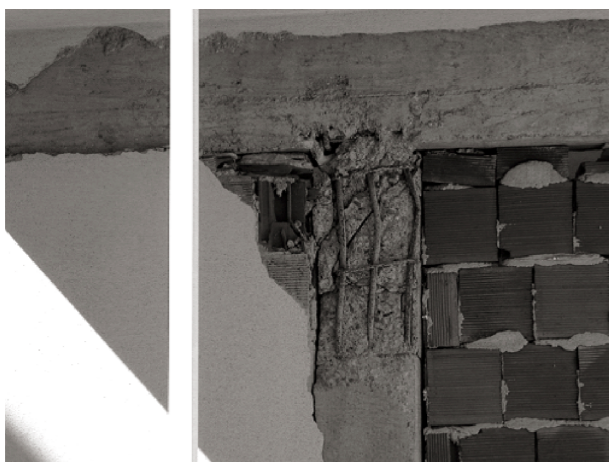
Vinclament de les barres longitudinals per falta d'armadura transversal.
